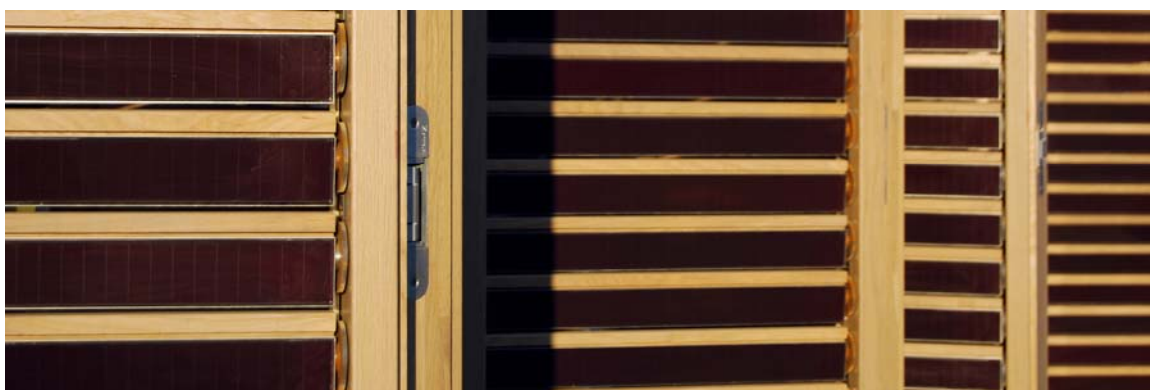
Fassadenausschnitt der Lamellenfassade, Quelle: FG\_ee
